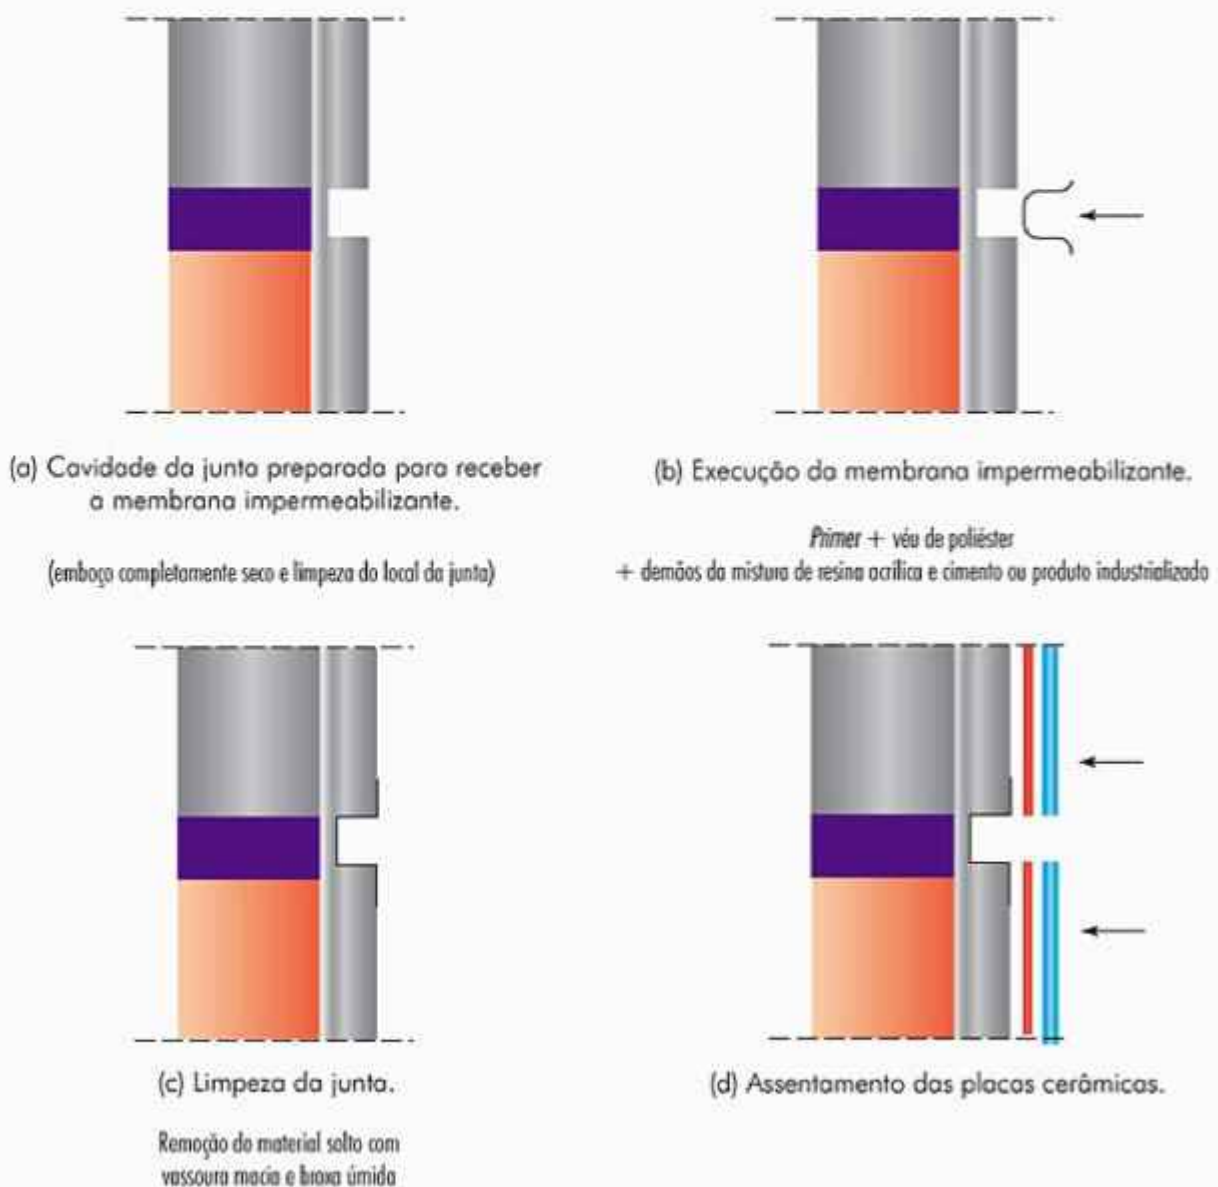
Juntas de Trabalho: tratamento impermeabilizante da abertura da junta.
